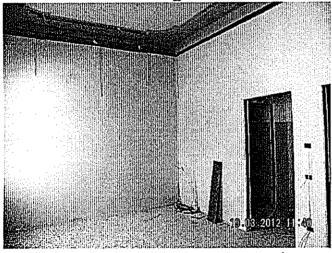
Stanza 1.1: Vista porta ingresso bagno (stanza_1.2)
